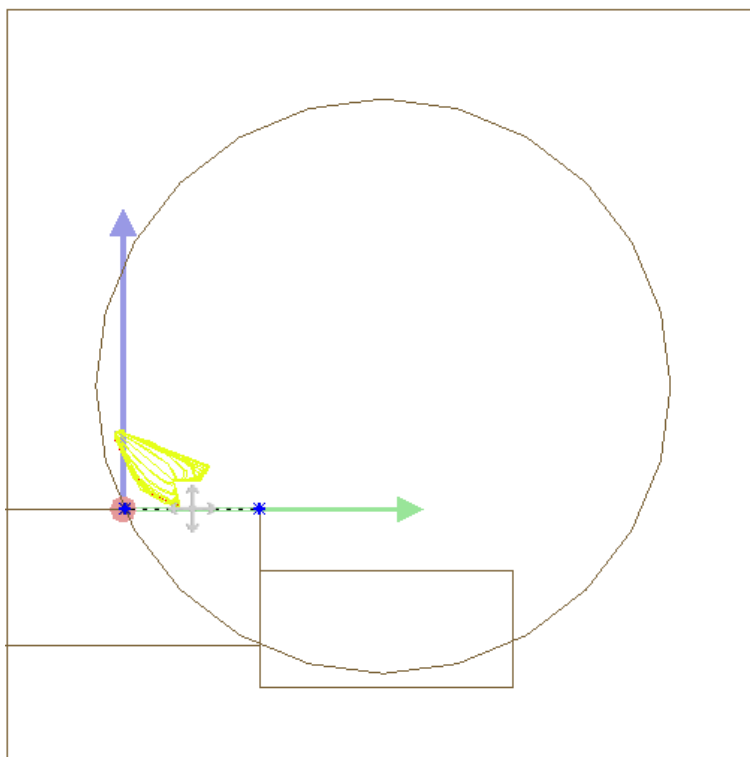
Vista laterale SC modello galleria calcolo preliminare
